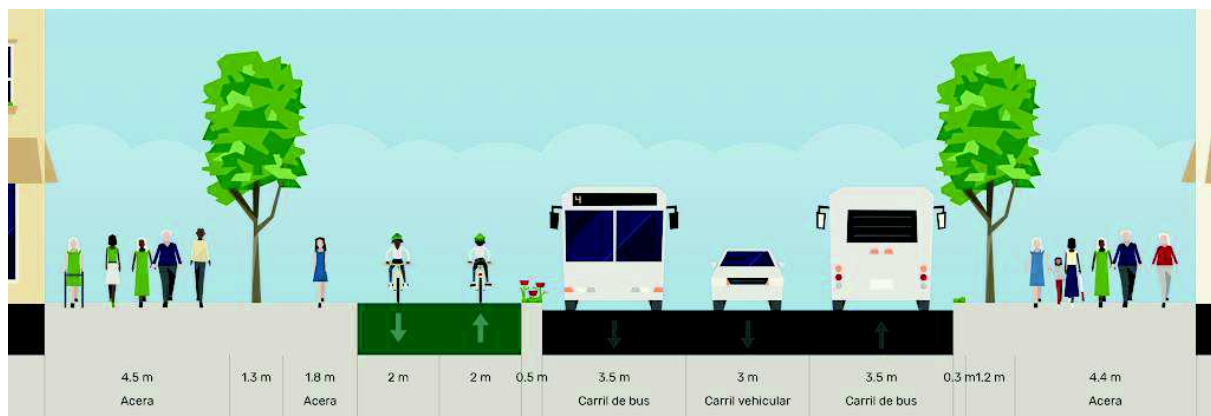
Sección propuesta en la calle María Auxiliadora, junto a la Trinidad
